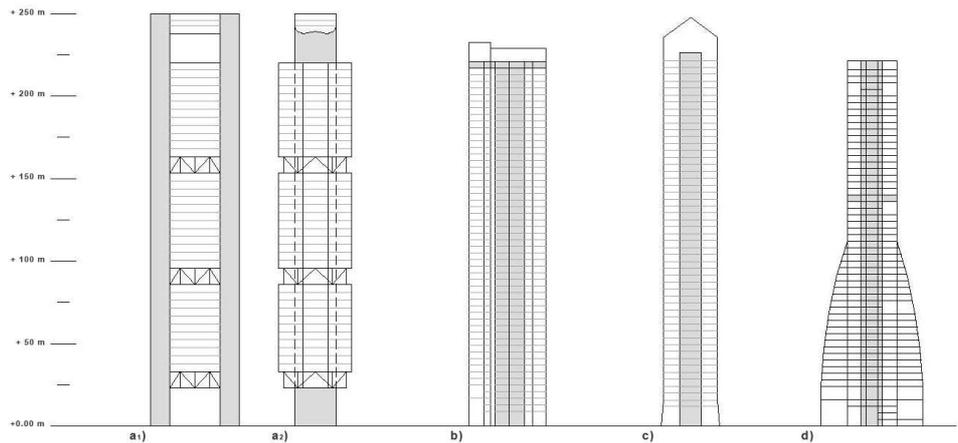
Sección esquemática de las torres comparando la disposición de los elementos resistentes frente acción horizontal: a1) alzado sur de la Torre Bankia, a2) sección transversal norte-sur de la Torre Bankia, b) sección longitudinal de la Torre PwC, c) sección longitudinal de la Torre de Cristal, d) sección longitudinal de la Torre Espacio.
